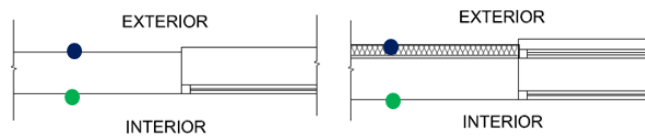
Sección horizontal de las fachadas donde se muestra la ubicación de los termopares.
